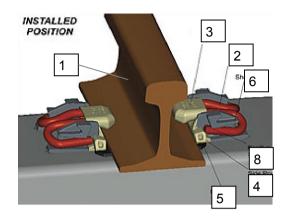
Поперечный разрез угловой планки для скрепления W (Vossloh)
